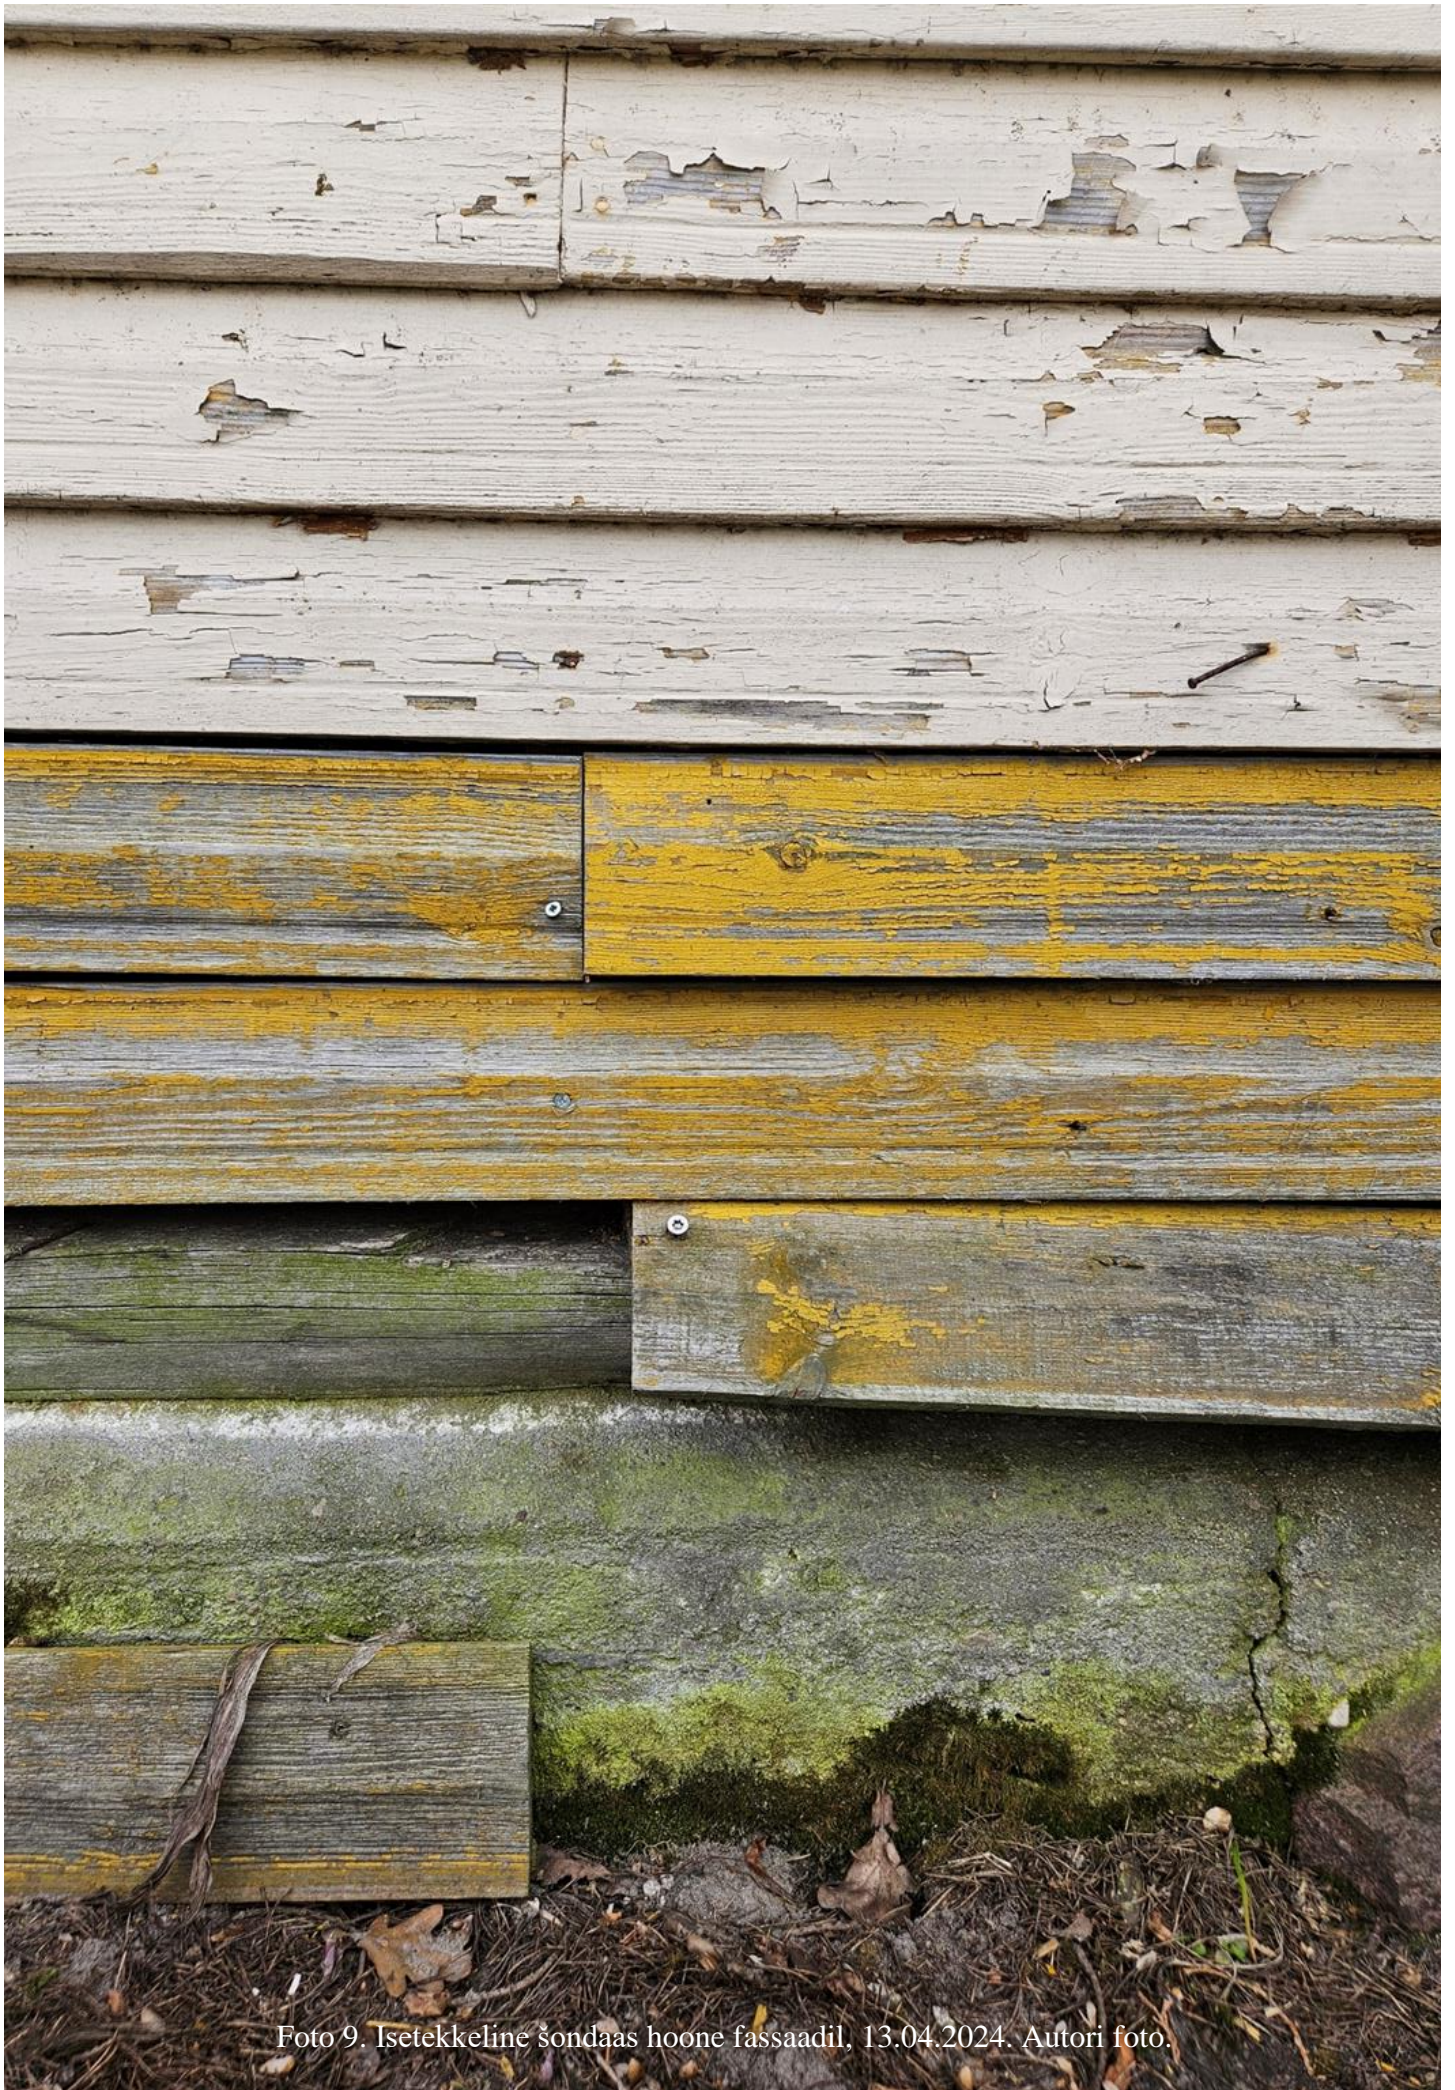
Isetekkeline šondaas hoone fassaadil, 13.04.2024. Autori foto.
